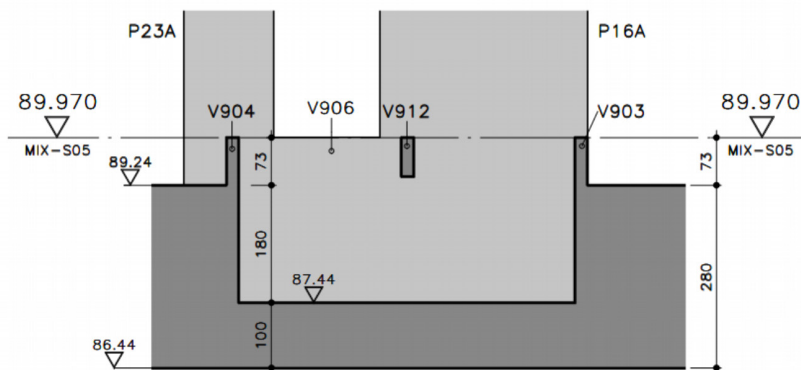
Cortes e detalhamentos da fundação – setor 9: corte D
